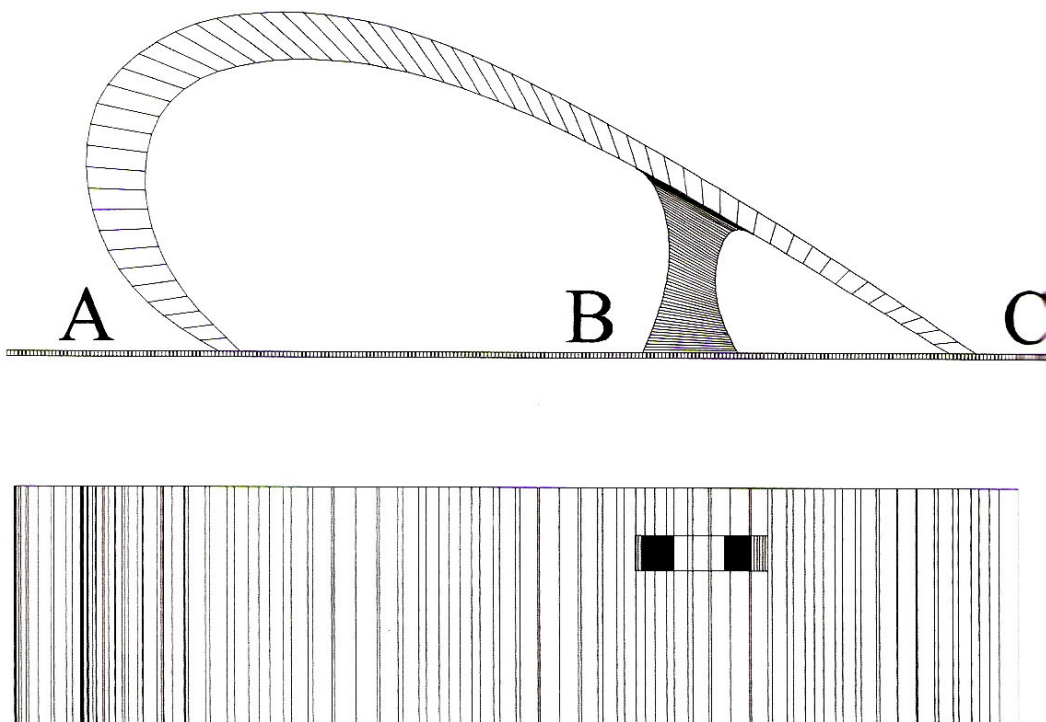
Forma esquemática do monumento – planta e elevação (Capítulo 9, Acidentes Estruturais na Construção Civil, 1998).
